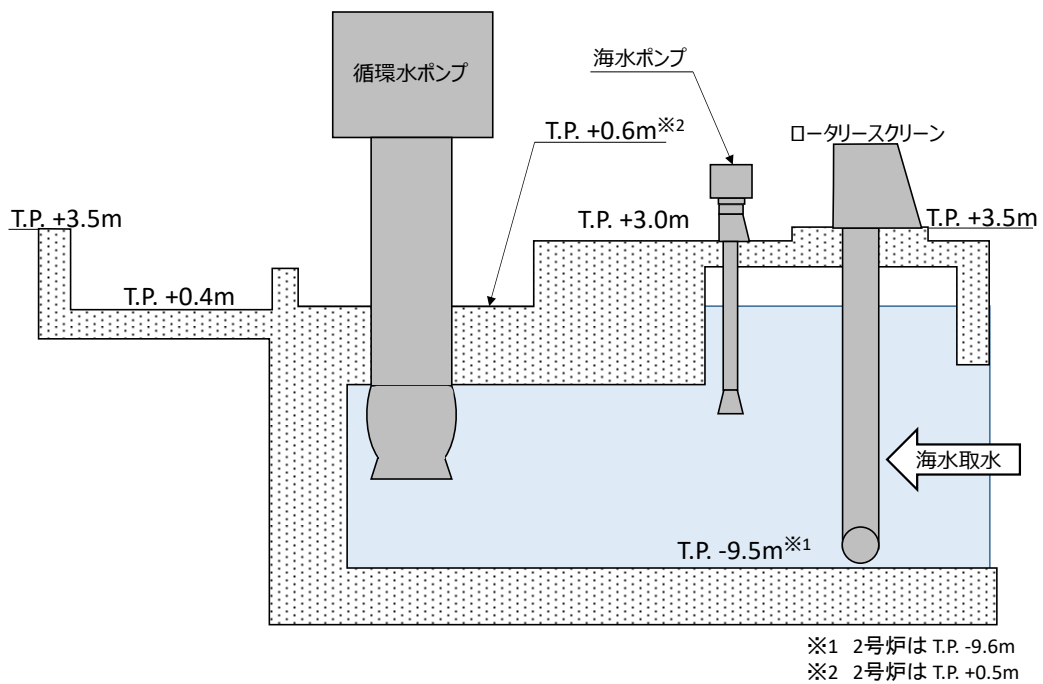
1号及び2号炉海水取水設備（断面図）
